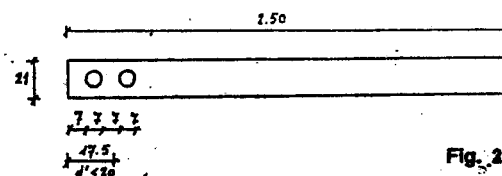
Poutre raidisseuse de tête. Coupe transversale
